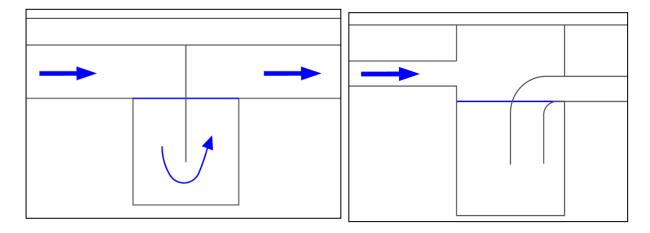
Schémas de principe de 2 exemples de zones de décantation (cloison siphoïde et coude PVC)
